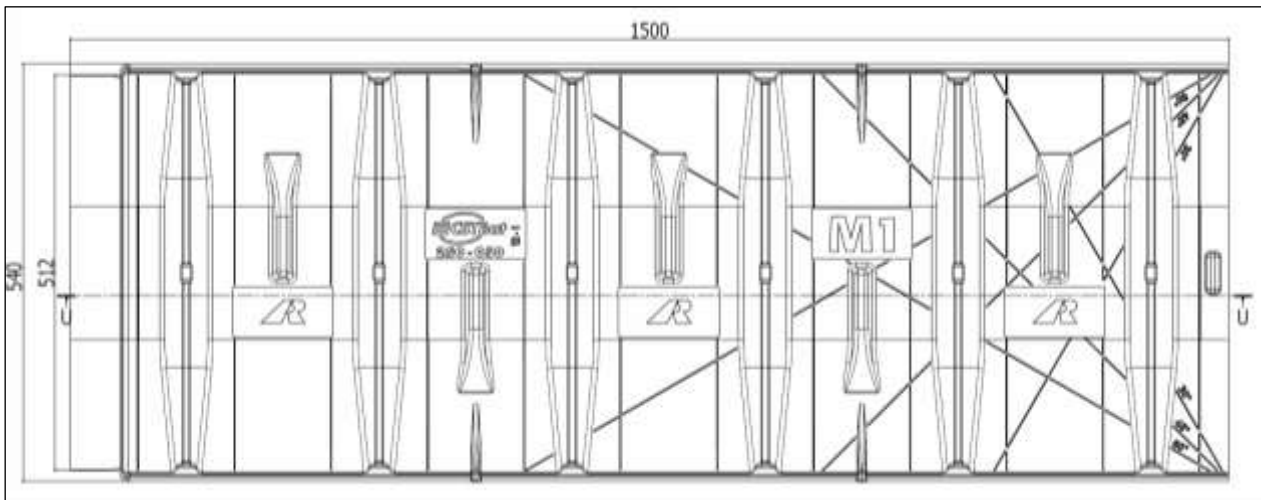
Entrevous Neobois (longueur 1333 mm) hauteur coffrante 120 mm
